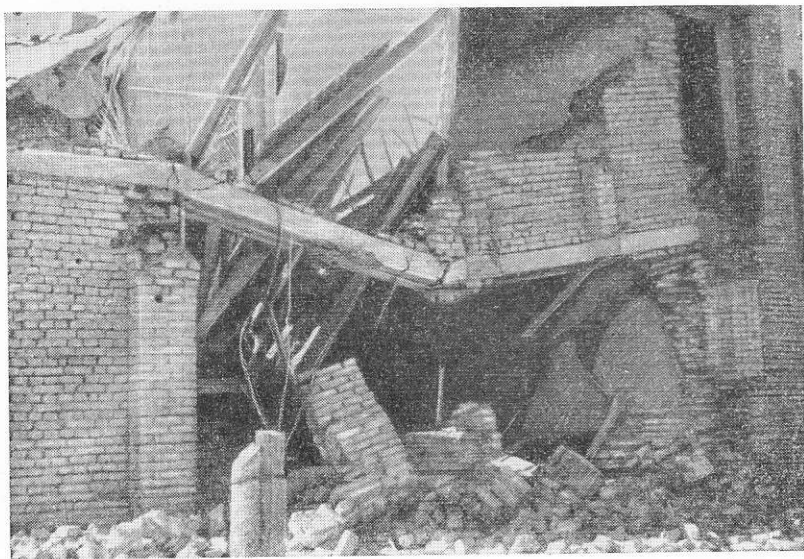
Разрушение висячей стены и железобетонного прогона — пояса читально-библиотечной части здания
